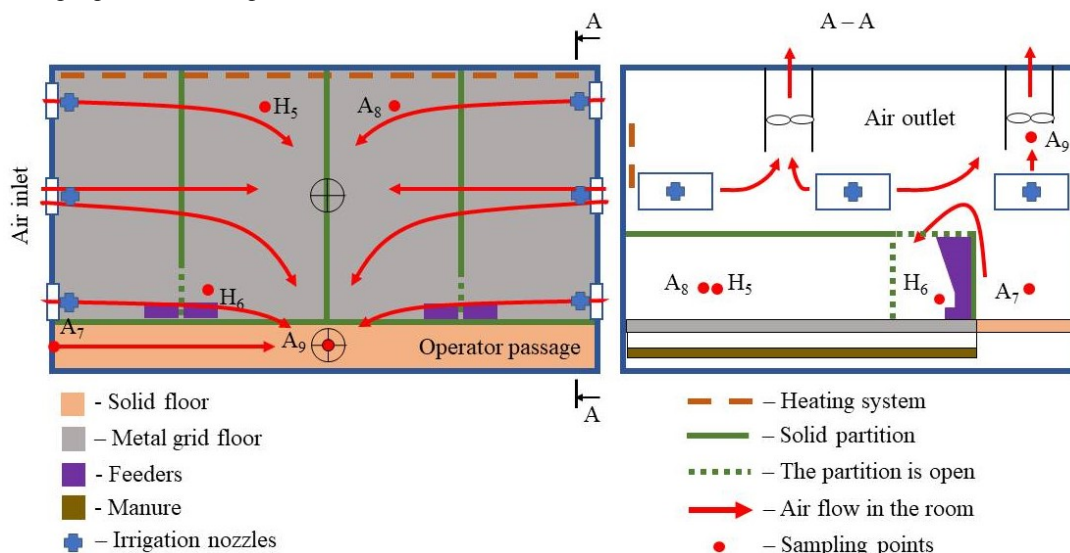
Схема приміщенні із системою вентиляції через стінові канали (варіант 3)
